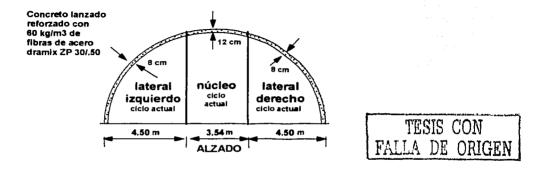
aplicación de concreto lanzado en las zonas excavadas.
